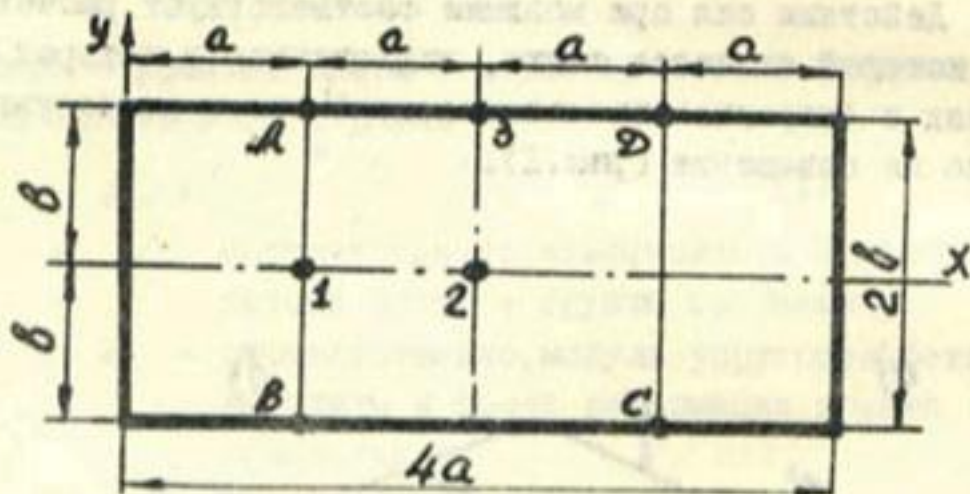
Проектирование гибких связанных железобетонных плит облицовок каналов.
